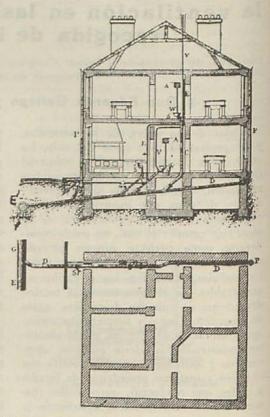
Ventilación de las alcantarillas por las tuberías de las casas. (Supresión del sifón terminal)
